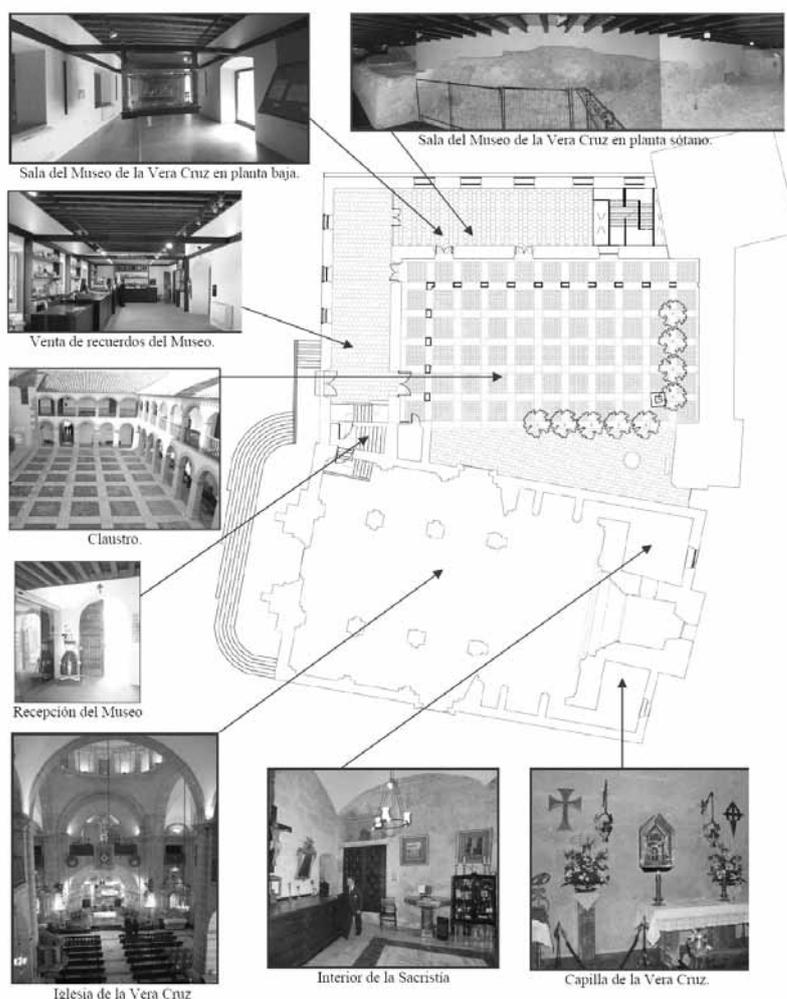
Plano descriptivo de las estancias de la planta baja de la Basílica.⁸
